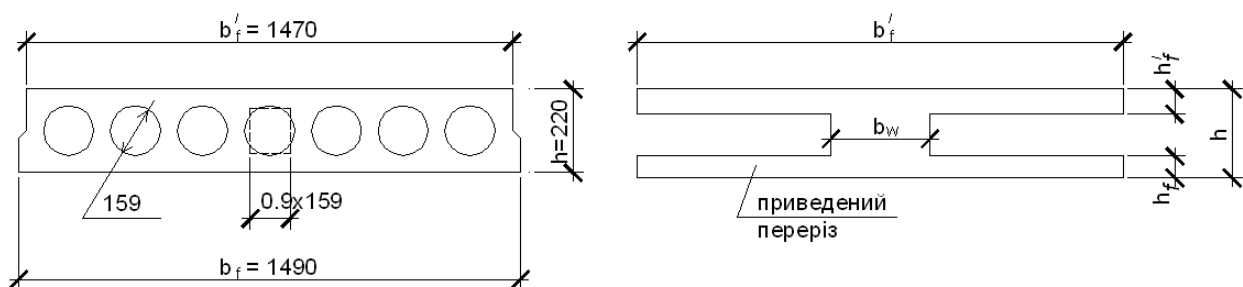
Розрахунковий переріз багатопустотної плити перекриття
